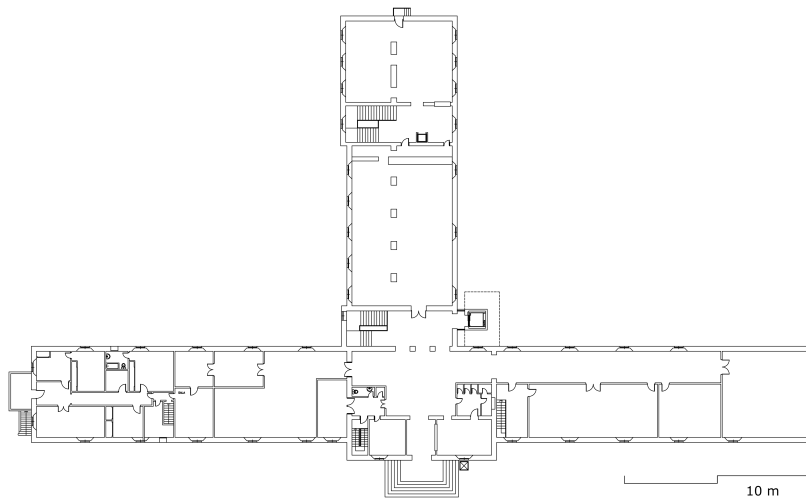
Plano de planta baja del Colegio Mayor Hernando Colón.
